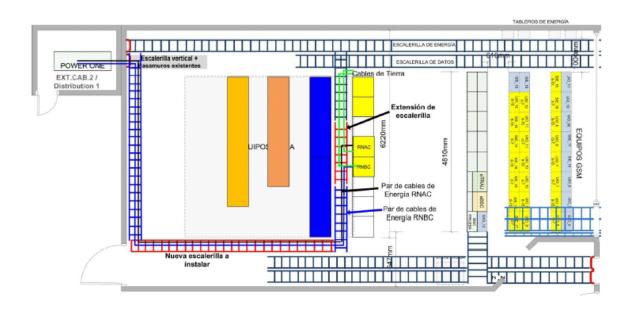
PLANOS PARA EL RACK DE FUERZA
